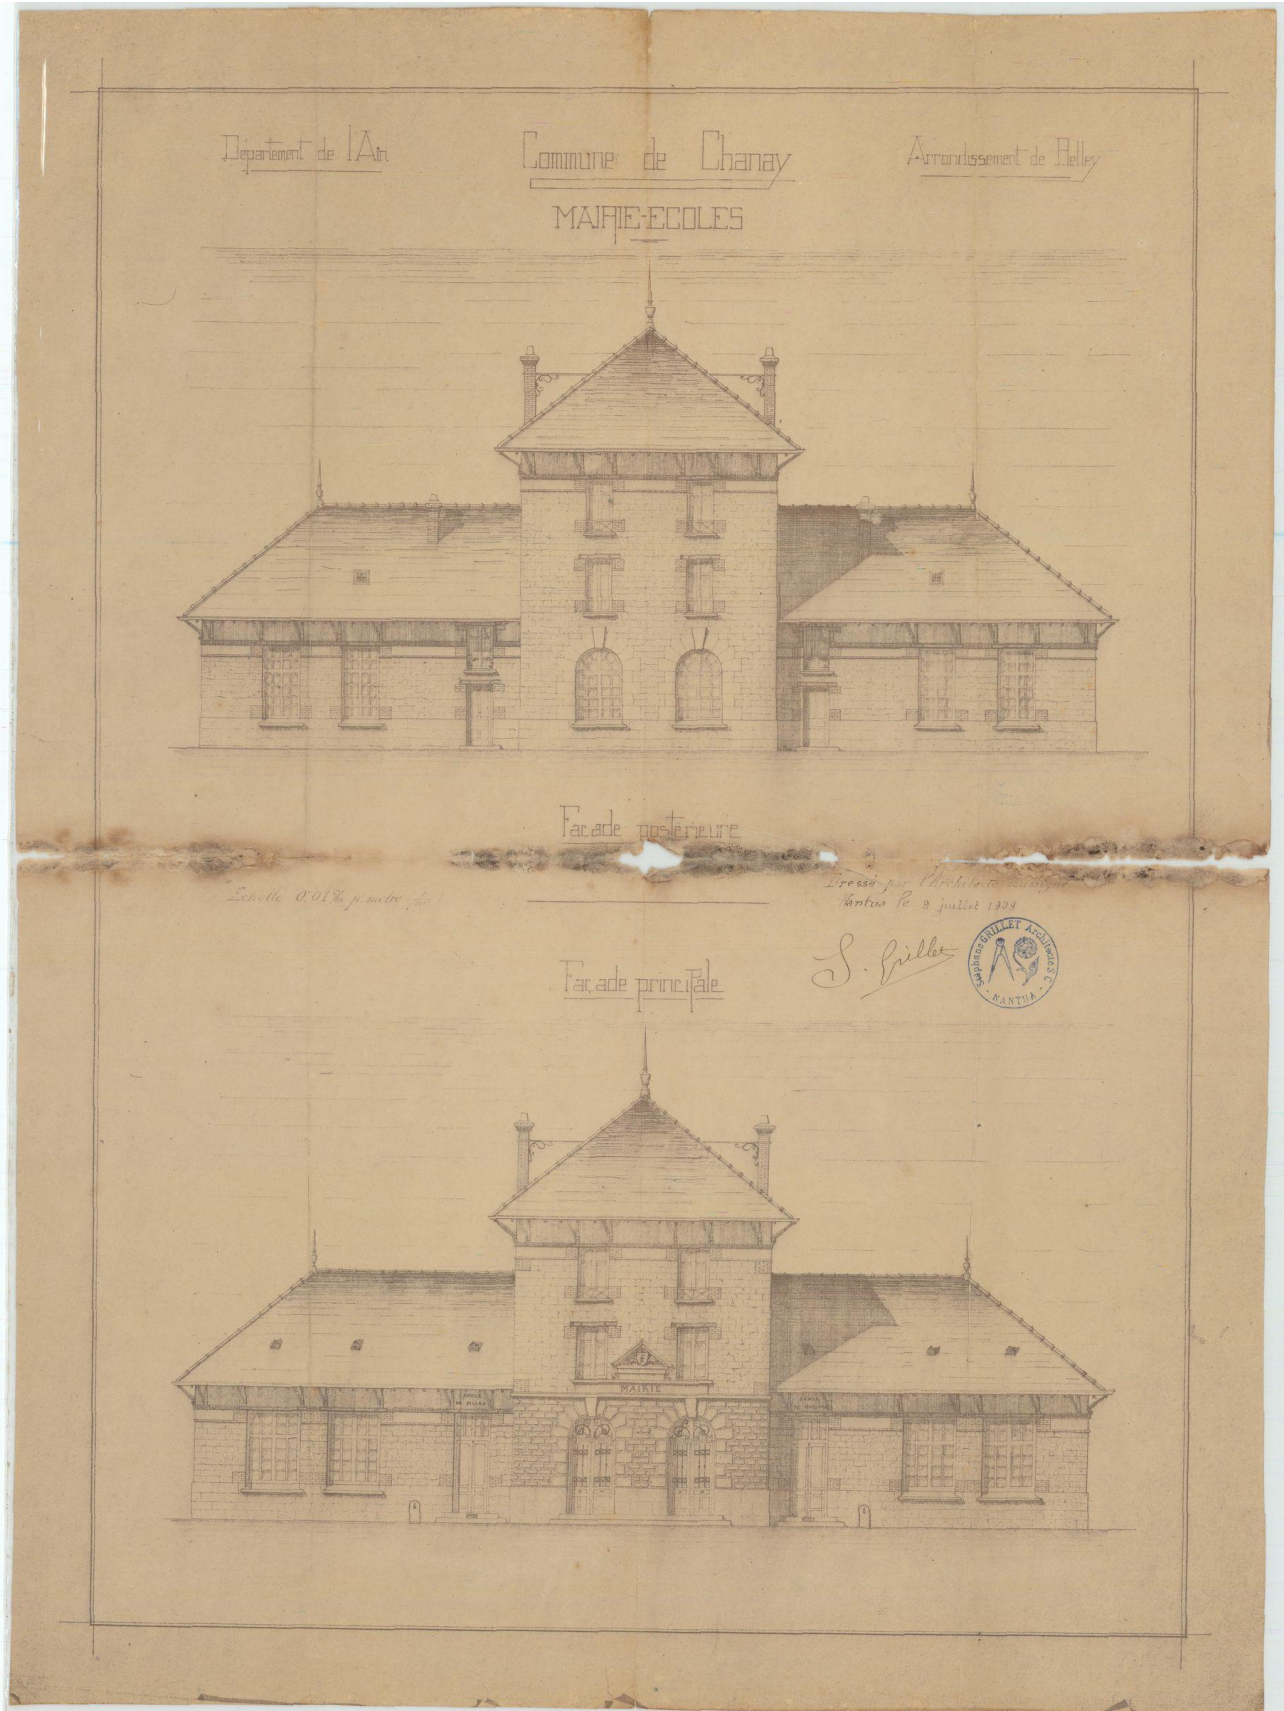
Plan pour la construction de la mairie-école, M1 (1909).
